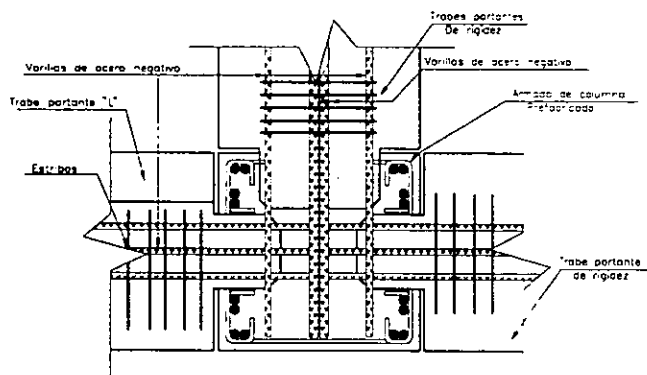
Vista en planta del armado del nodo trabe-columna.
